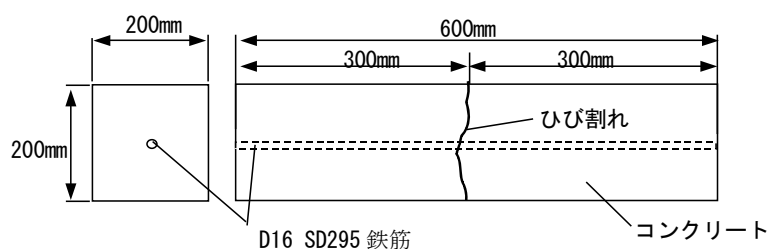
試験体の形状・寸法およびひび割れの導入位置
